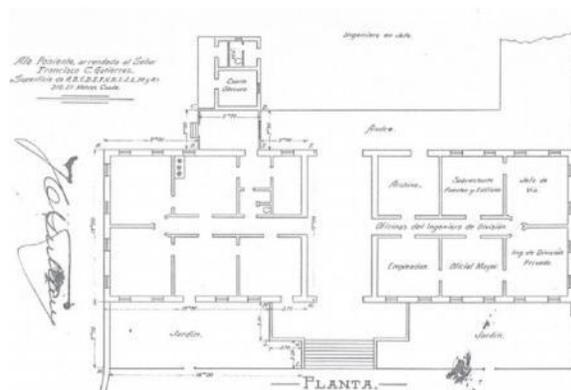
Planta de la antigua estación ferrocarrilera de Puebla
